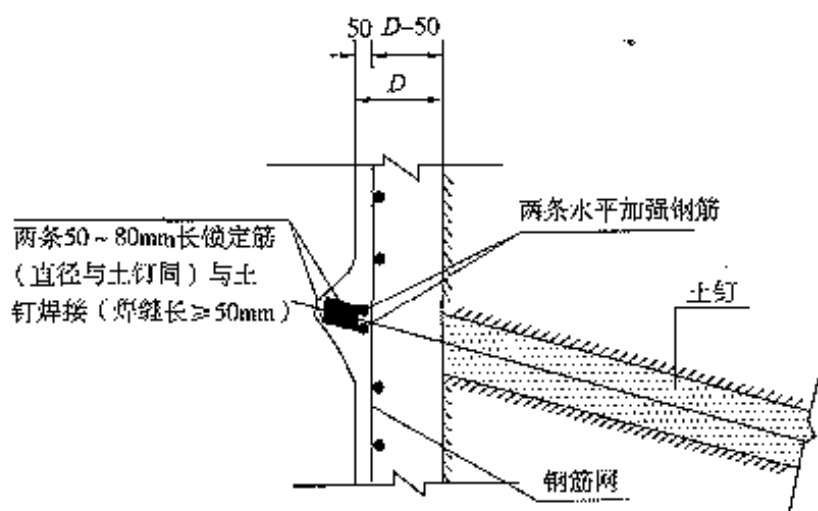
钢筋网与钉头的固定(尺寸单位:mm)
